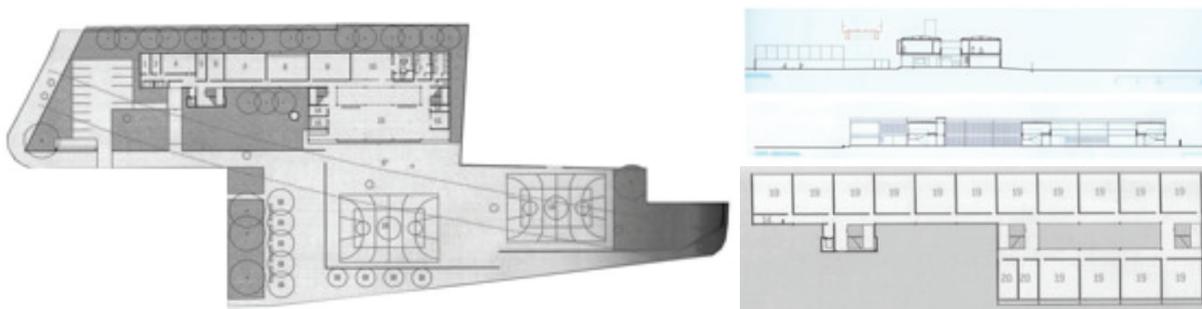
FDE - Escola República do Panamá em São Paulo. Implantação (a esquerda), elevações e planta do pavimento.
